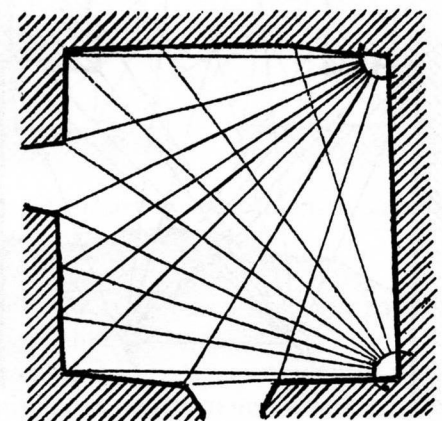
Обмер плана помещения засечками при одной стене, принятой за базис
